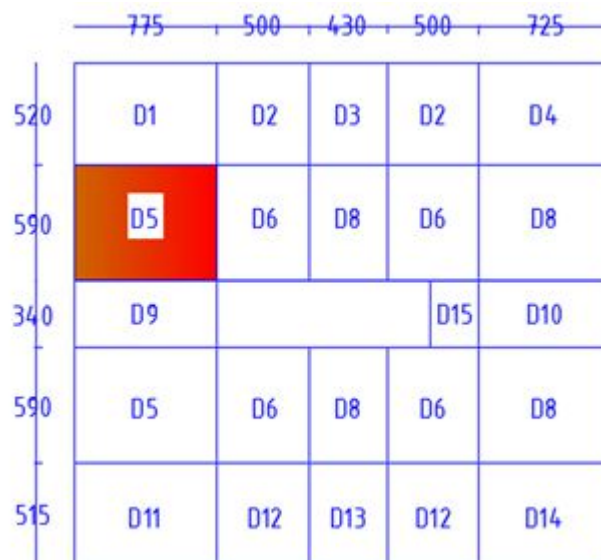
Représentation du panneau D5 sur le plancher considéré.
